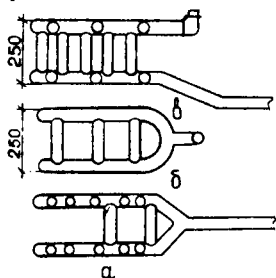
Схема устройства змеевиков: а — низ; б — верх змеевика; в — вид сбоку
